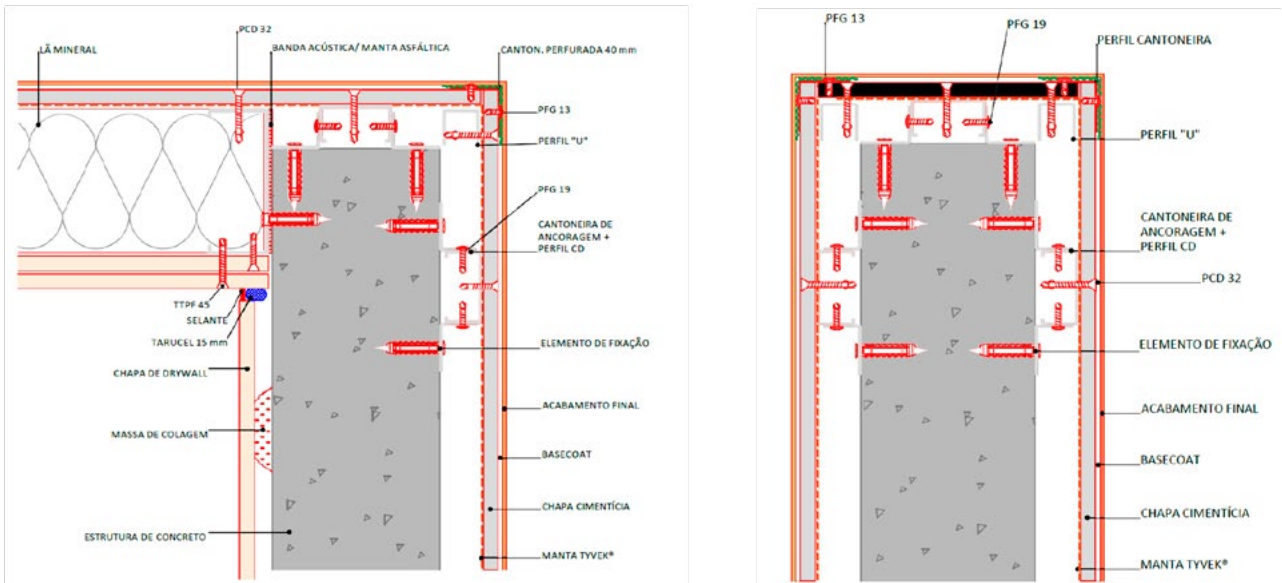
Esquema do requadro do pilar com Placa Cimentícia Brasilit.
